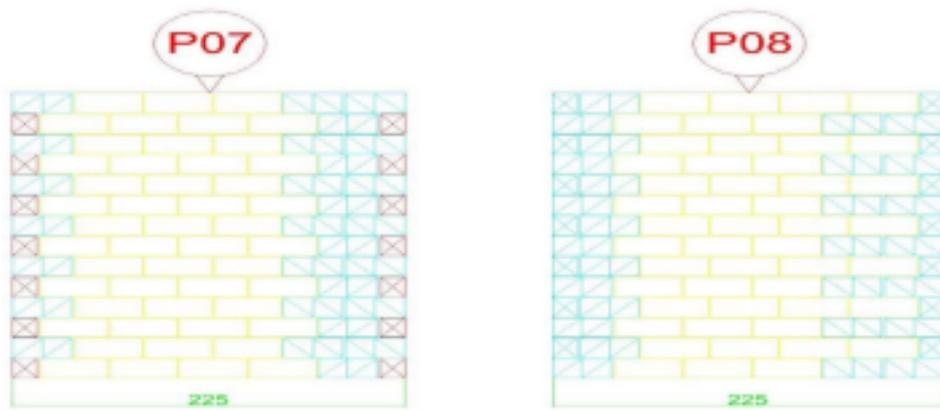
e 5: Modulação dos blocos estruturais de concreto do projeto executado
